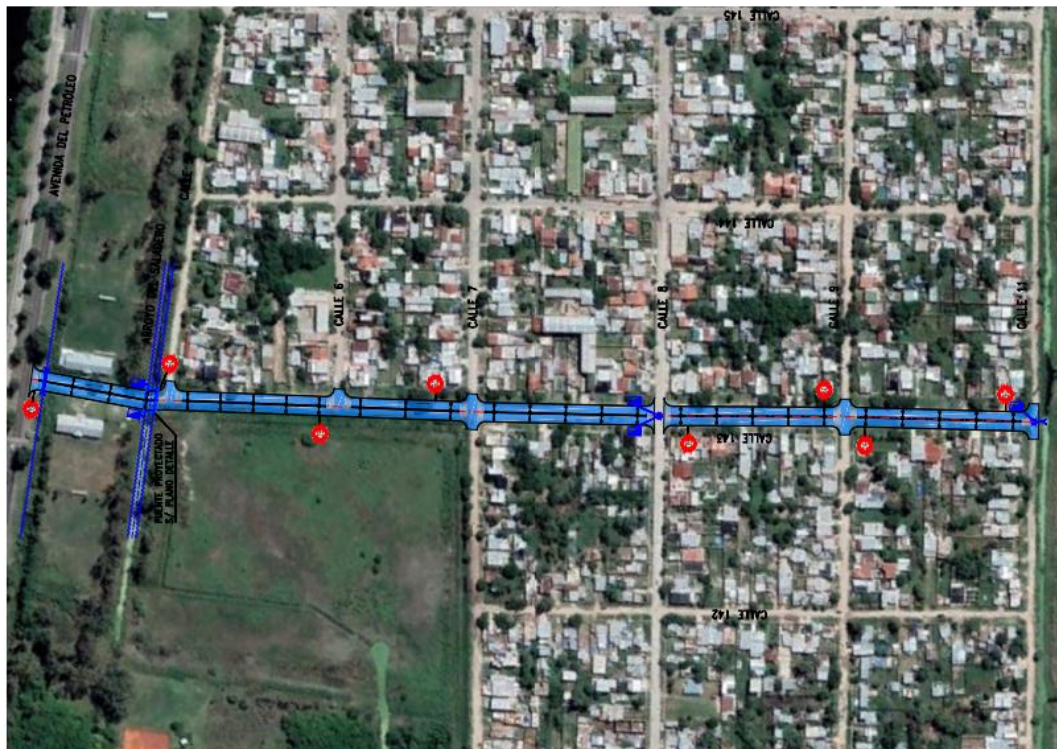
Proyecto de pavimentación de la Calle 143. Fuente: Municipalidad de Berisso.
